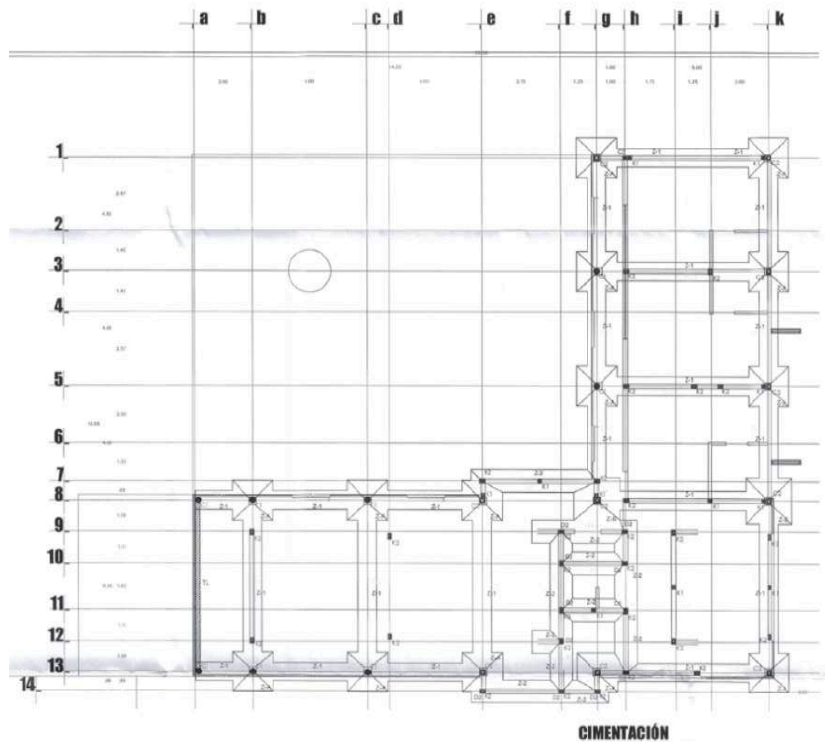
Planta de cimentación. El dibujo de la planta de cimentación es propiedad del constructor el cual realizó el dibujo.
